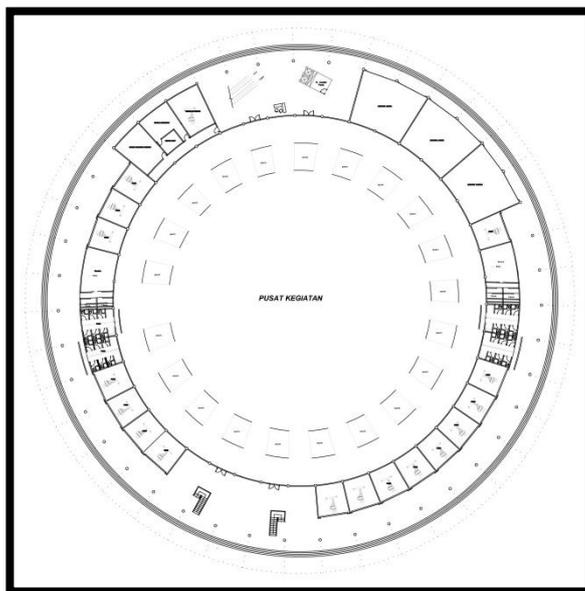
Rencana air bersih bangunan paddock dan tribun
